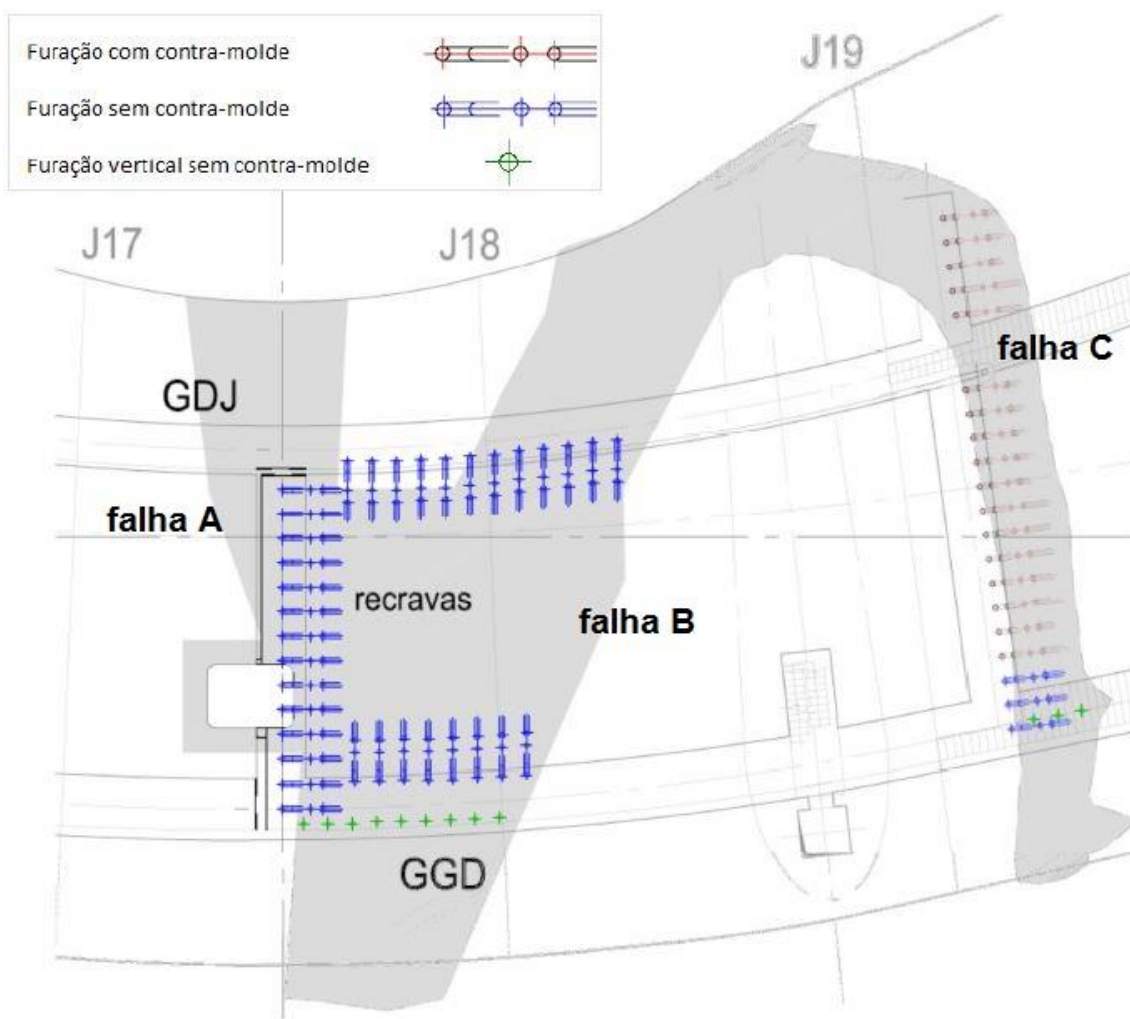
Esquema em planta da furação para tratamento das falhas A,B e C
